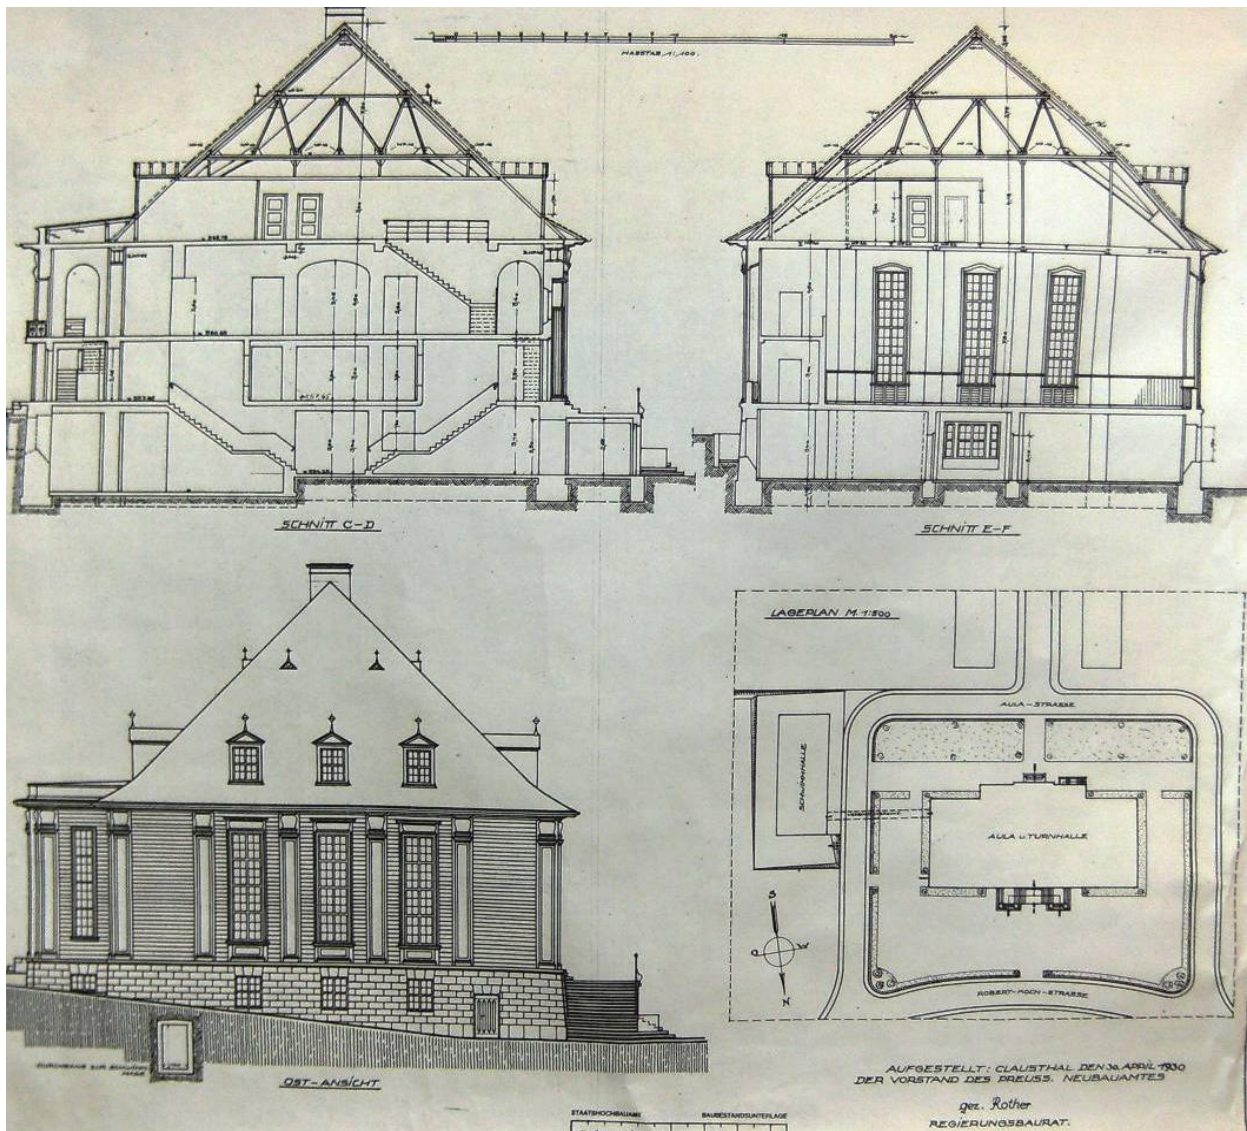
Ost-Ansicht der Aula, Schnitte und Lageplan. Aufgestellt am 30. 4. 1930. Rother erscheint in dem Plan als Regierungsbaurat.
